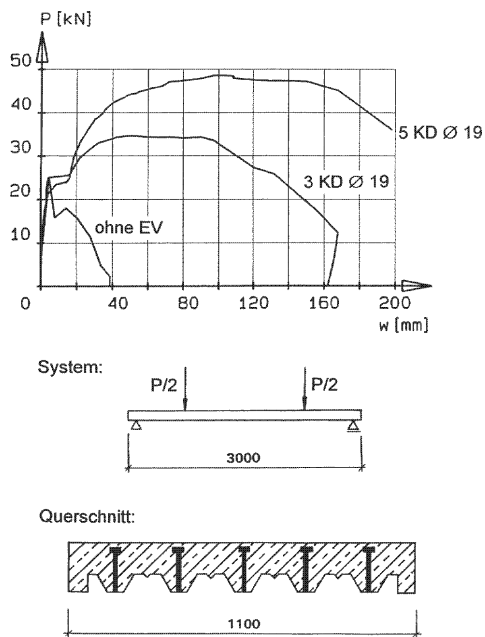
Tragverhalten einer Trapezprofil-Verbunddecke mit und ohne Endverankerungen
